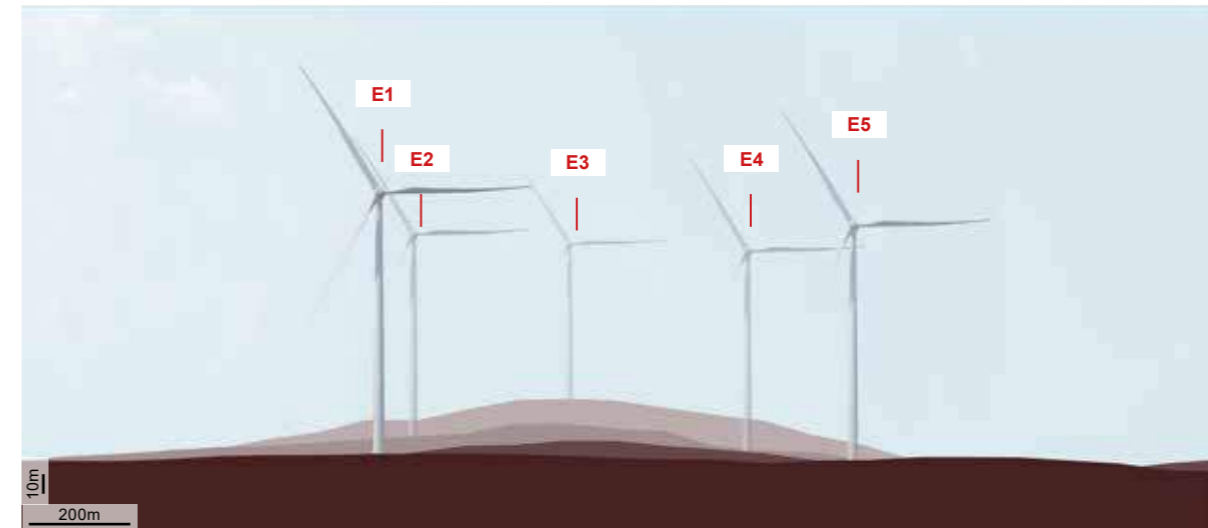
Coupe Nord-Est / Sud-Ouest (vue face au parc) variante 4
